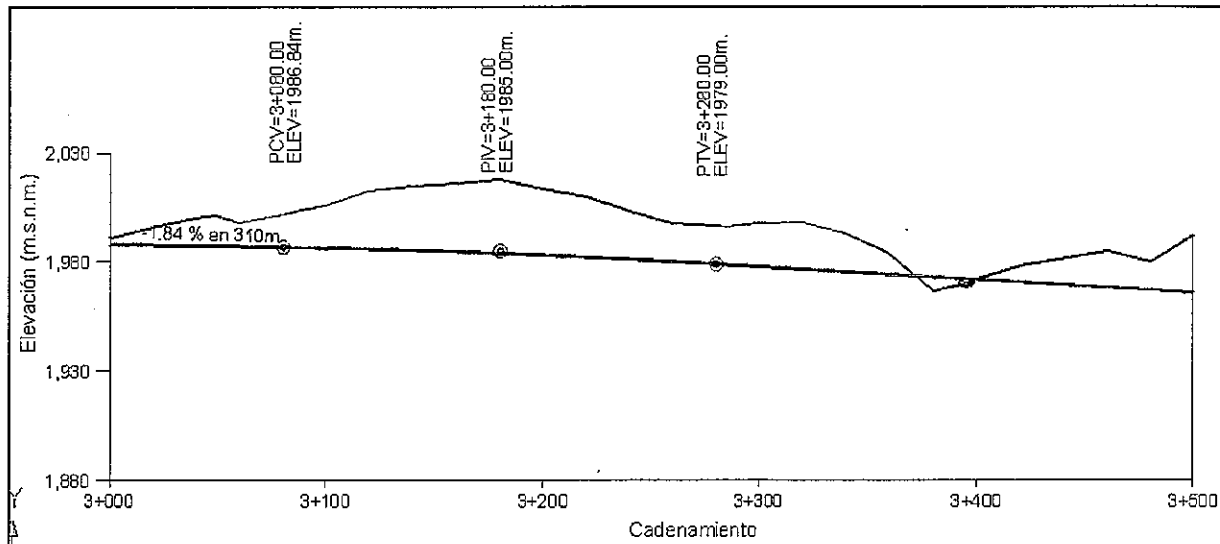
Perfil topográfico por el eje del camino en el Corte 2
